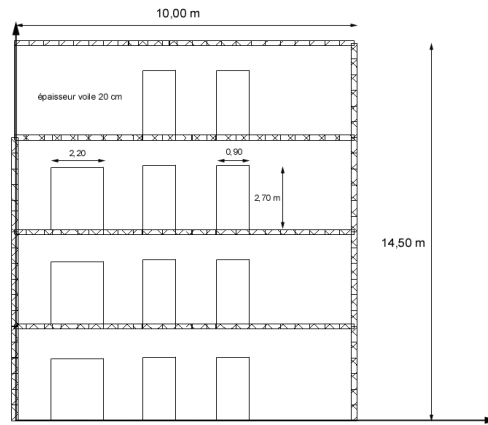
Vue en élévation d'un bâtiment diagnostiqué
